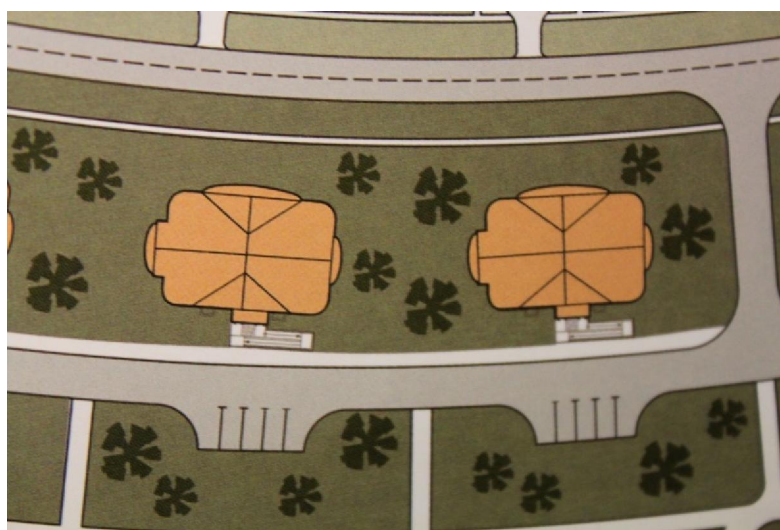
12-квартирный двухэтажный дом (вид сверху)
